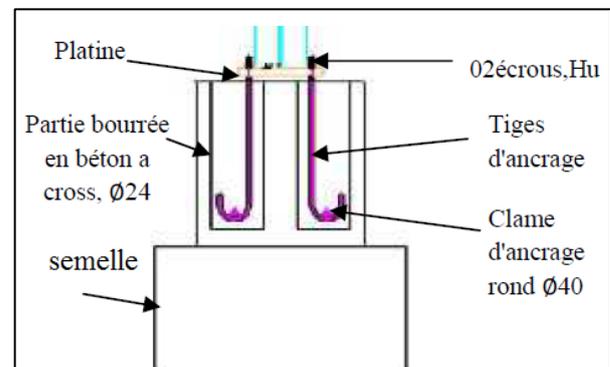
Articulation pied de poteau-fondation source : auteur 2019
